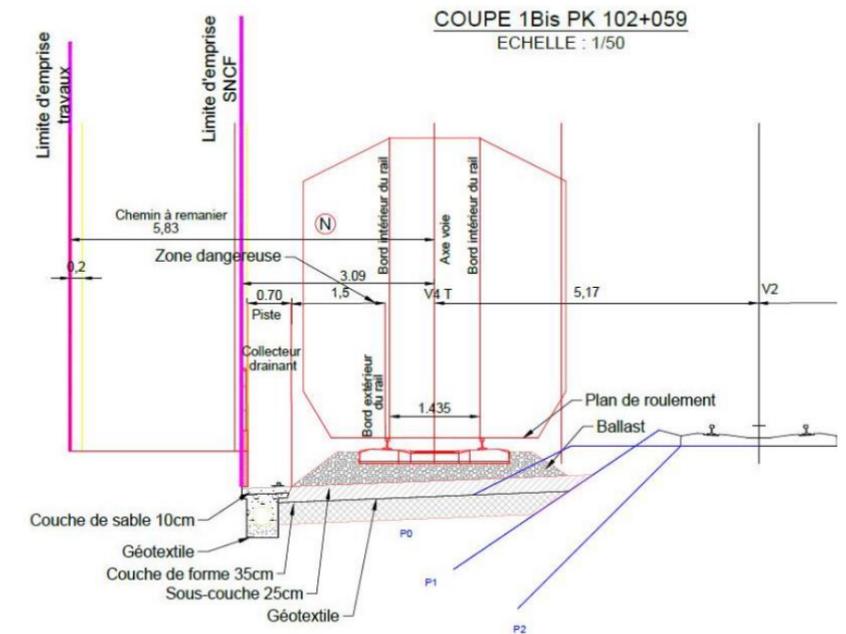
coupe voie 4 tiroir Carnoules Pk 102+059 avec collecteur drainant (Systra, 2021)
